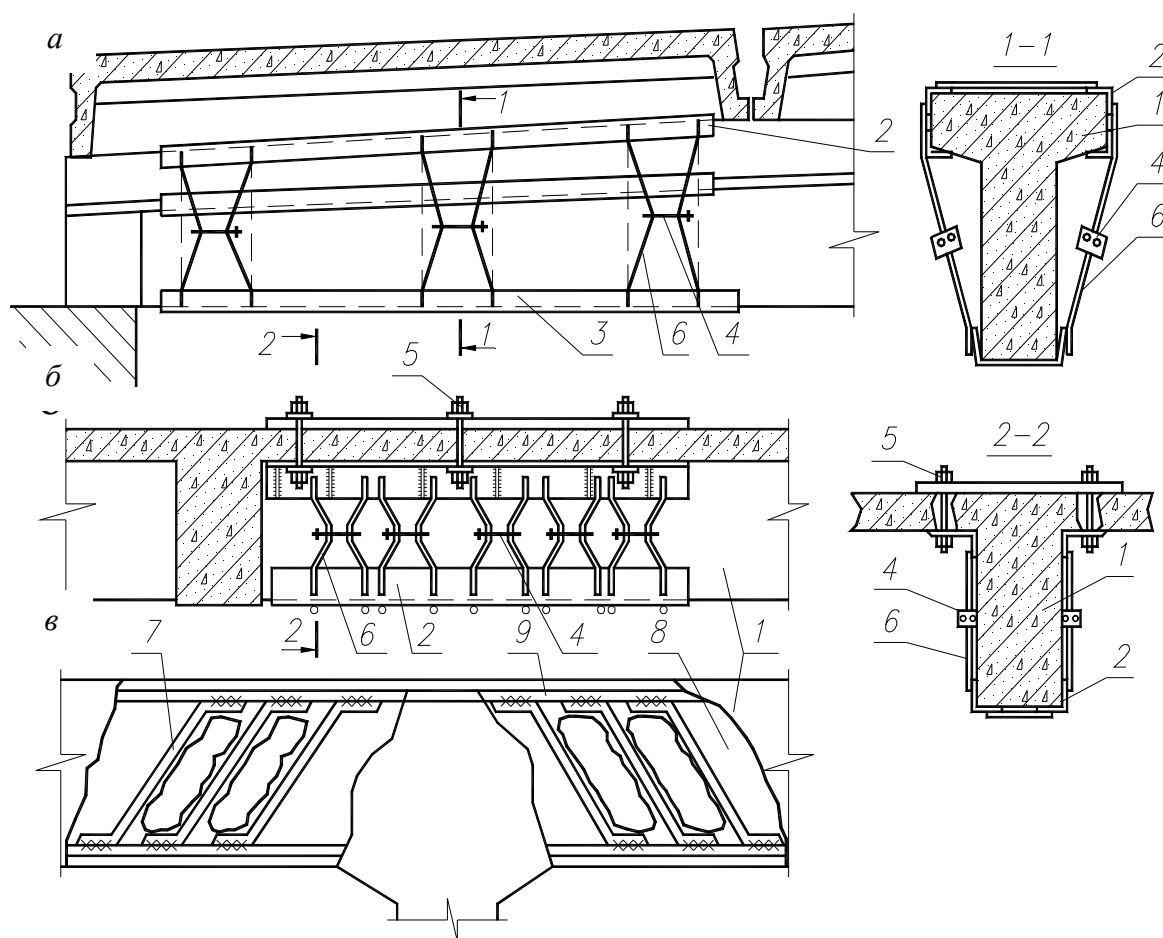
Усиление зоны среза конструкций установкой дополнительной поперечной арматуры: *а* – сборной балки; *б* – балки монолитного перекрытия; *в* – балки с наклонными стержнями, 1 – усиливаемая конструкция, 2 – уголок, 3 – швеллер, 4 – стяжной болт, 5 – болт, 6 – дополнительная поперечная арматура, 7 – накладная арматура, 8 – борозды на боковой поверхности, 9 – существующая арматура
